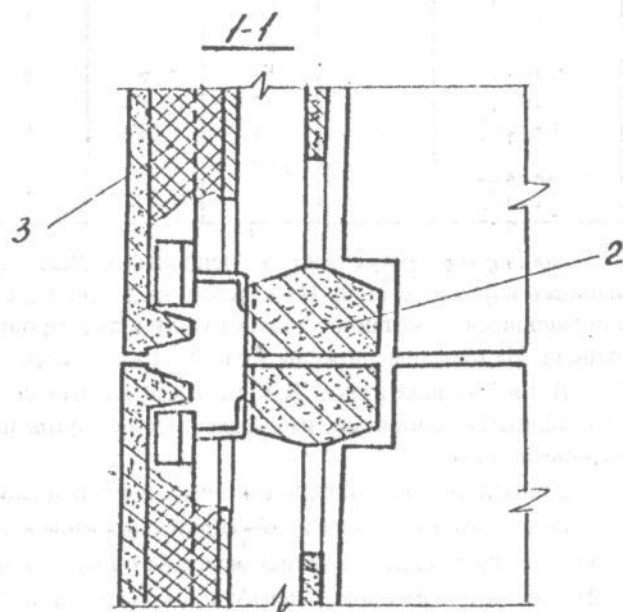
Крепление торцевых наружных стеновых панелей к железобетонным несущим панелям (поперечный разрез)
